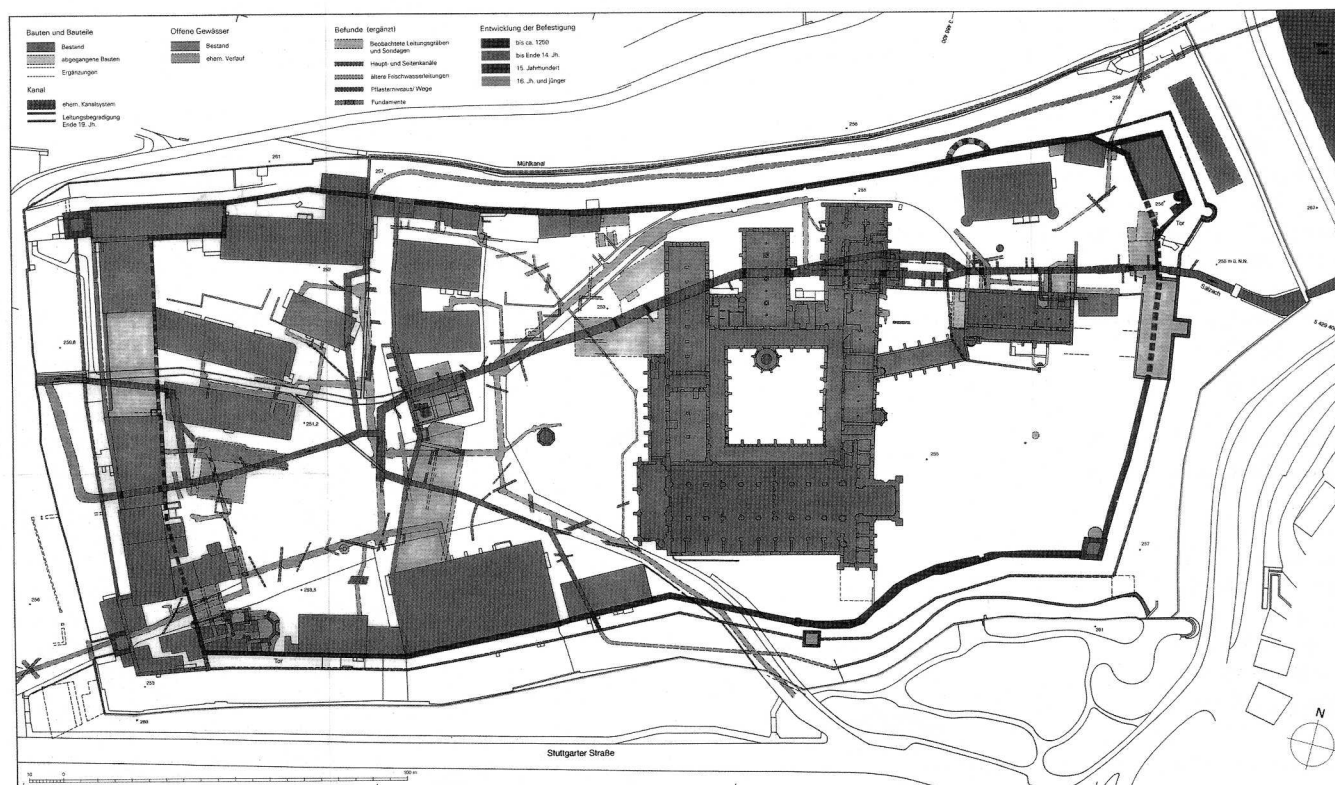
Lageplan des Klosterbereiches mit den bis jetzt bekannten Wasserführungen (nach O. Teschauer 1997).
